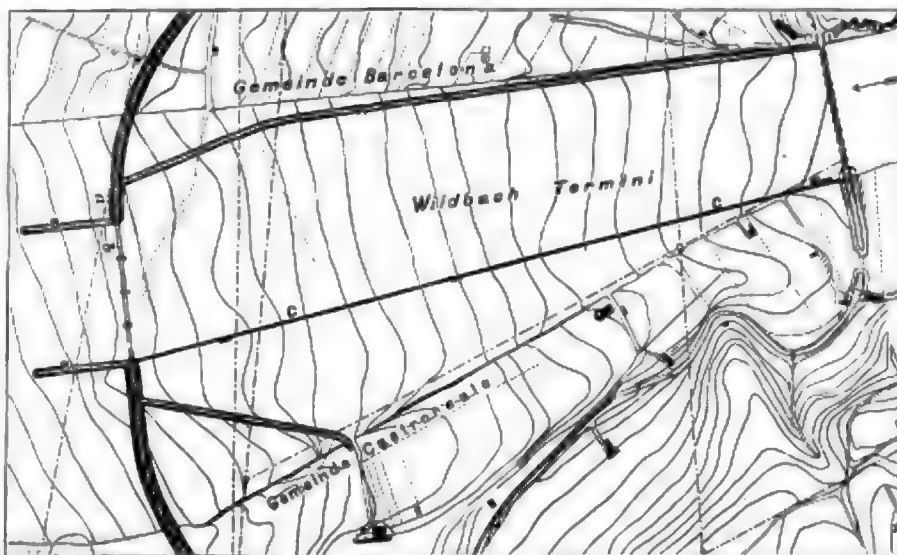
Lageplan der Unterführung des Wildwassers Termini.
